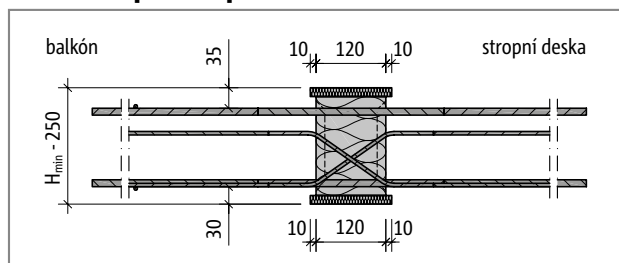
Schöck Isokorb® typ DXT70-VV6: Půdorys
